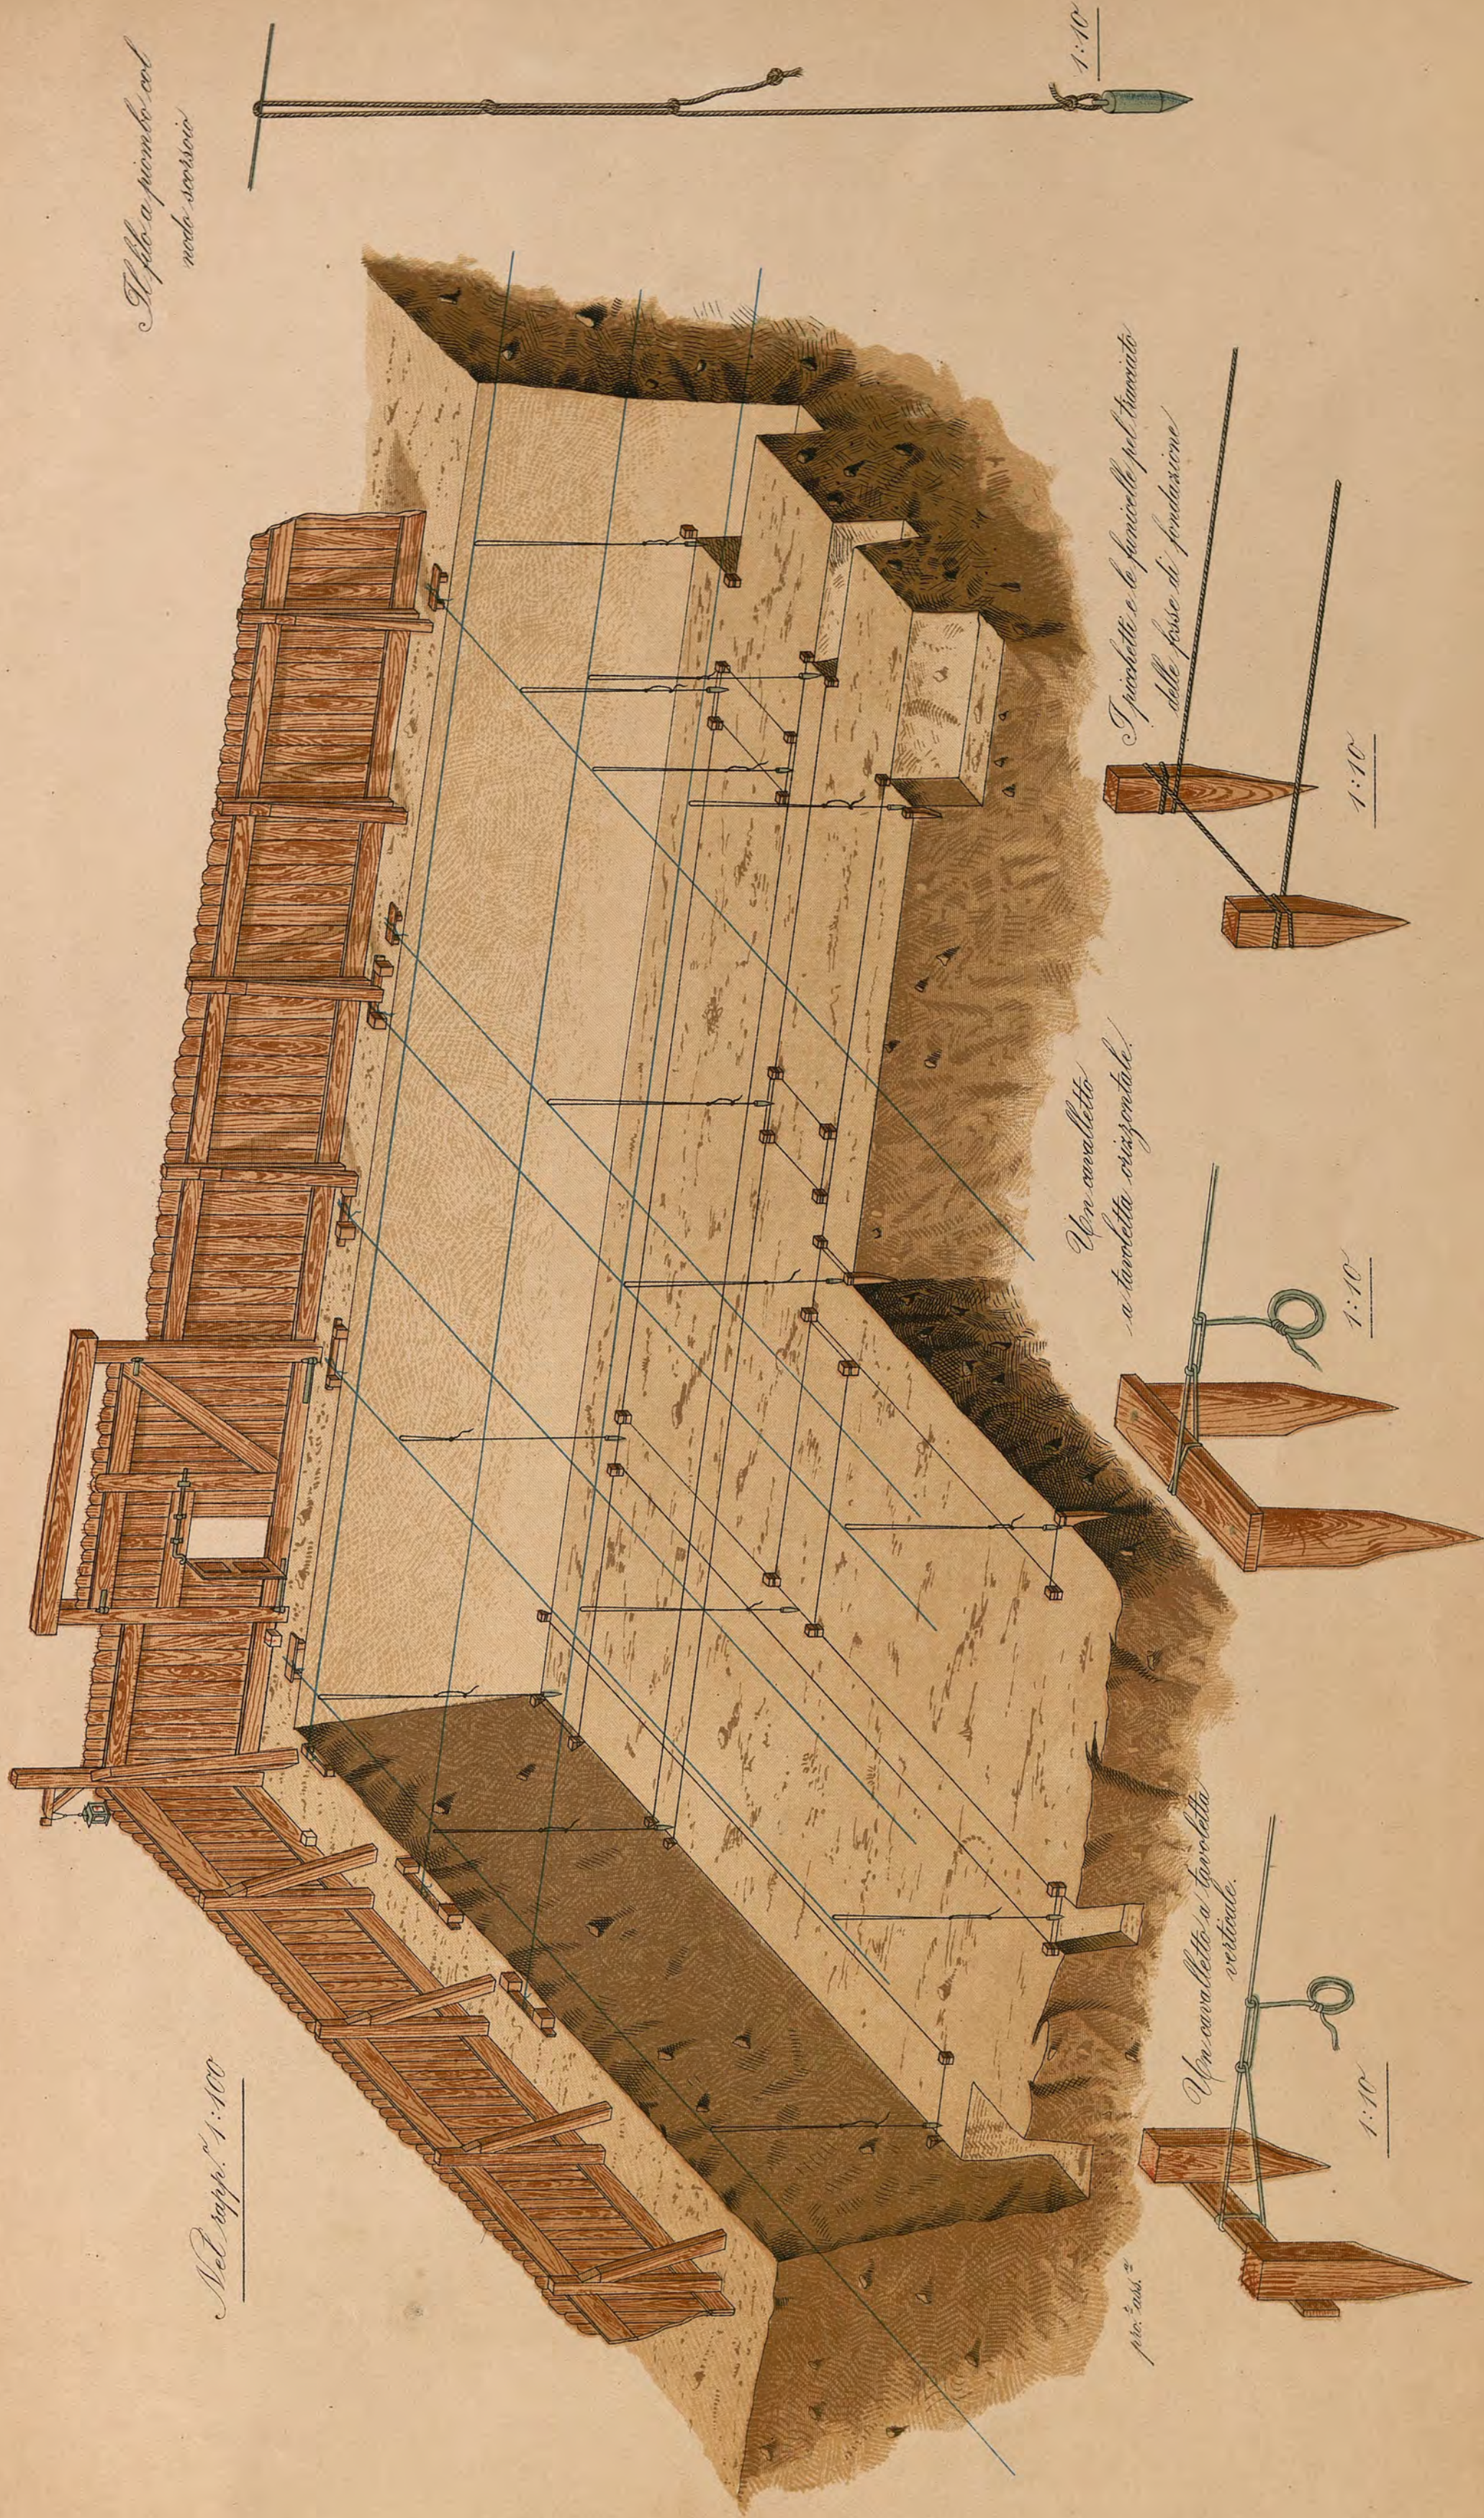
La pianta della platea di calcestruzzo colle fondamentate per l'incamminamento dei muri
